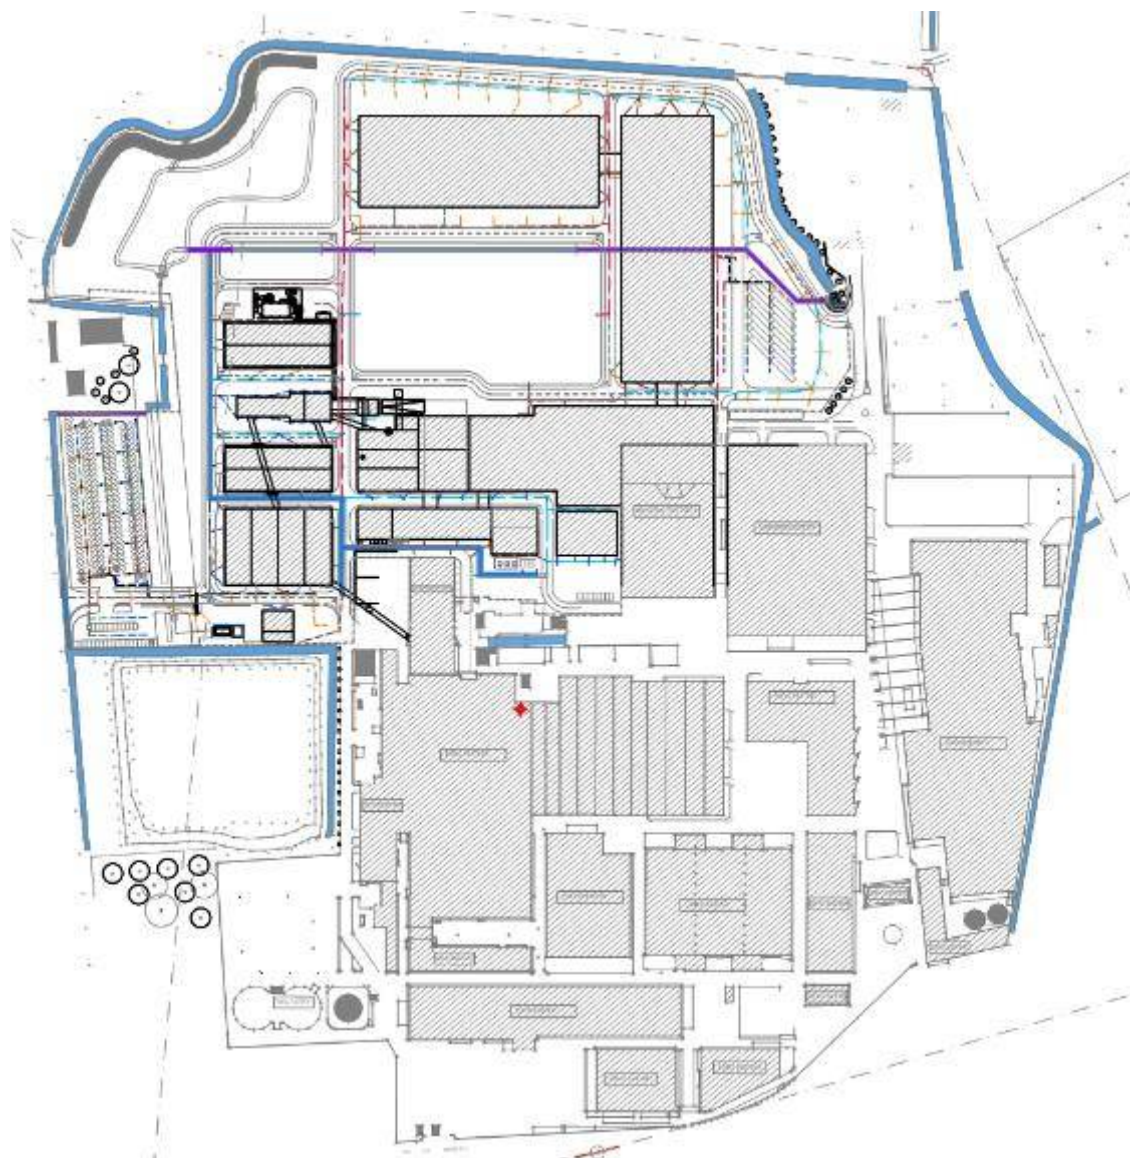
Planimetria dello stato di fatto – rilievo rete idrica esistente
